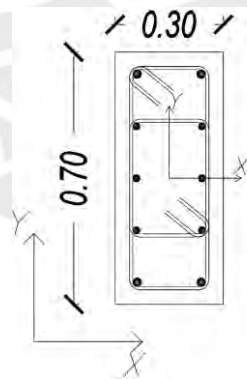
Sistema de ejes de la columna C-1 entre ejes C y 1
